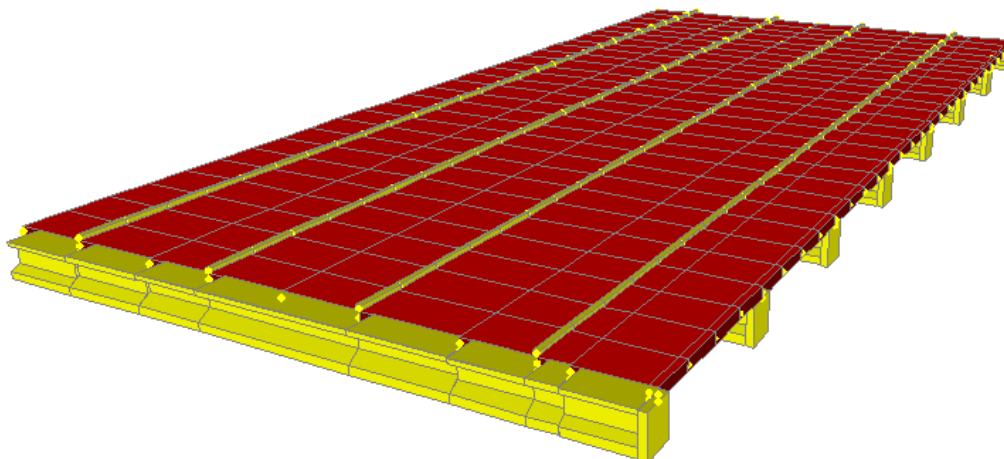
Esquema 3D de Modelo Utilizado en Losa Tipo, Acceso Sur Tramo Soterrado
